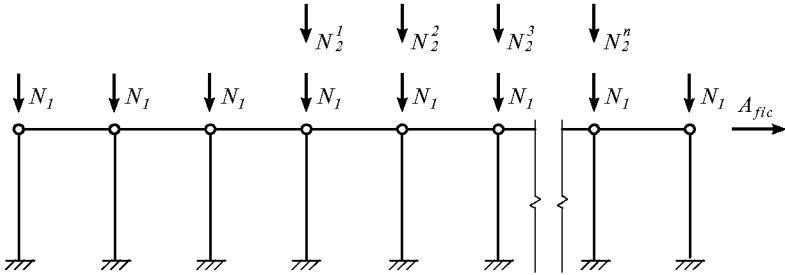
Схема определения условных горизонтальных сил, действующих на ряд колонн  $N_1$  - нормальная сила в колонне от постоянных и временных нагрузок (без учета нагрузок от кранов);  $N_2$  - нагрузка в колоннах от кранов;  $A_{fic}$  - условная горизонтальная сила, действующая на ряд колонн
